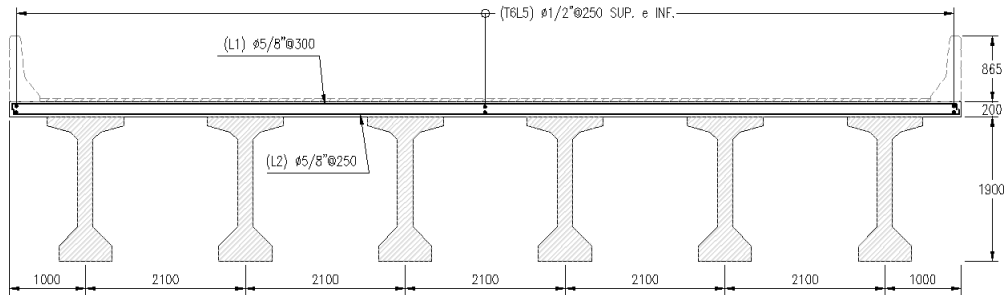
Resumen del refuerzo en la losa de concreto armado.
